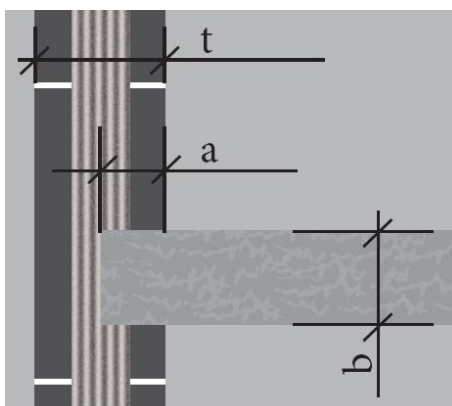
Detalhe de apoio de viga sobre alvenaria
